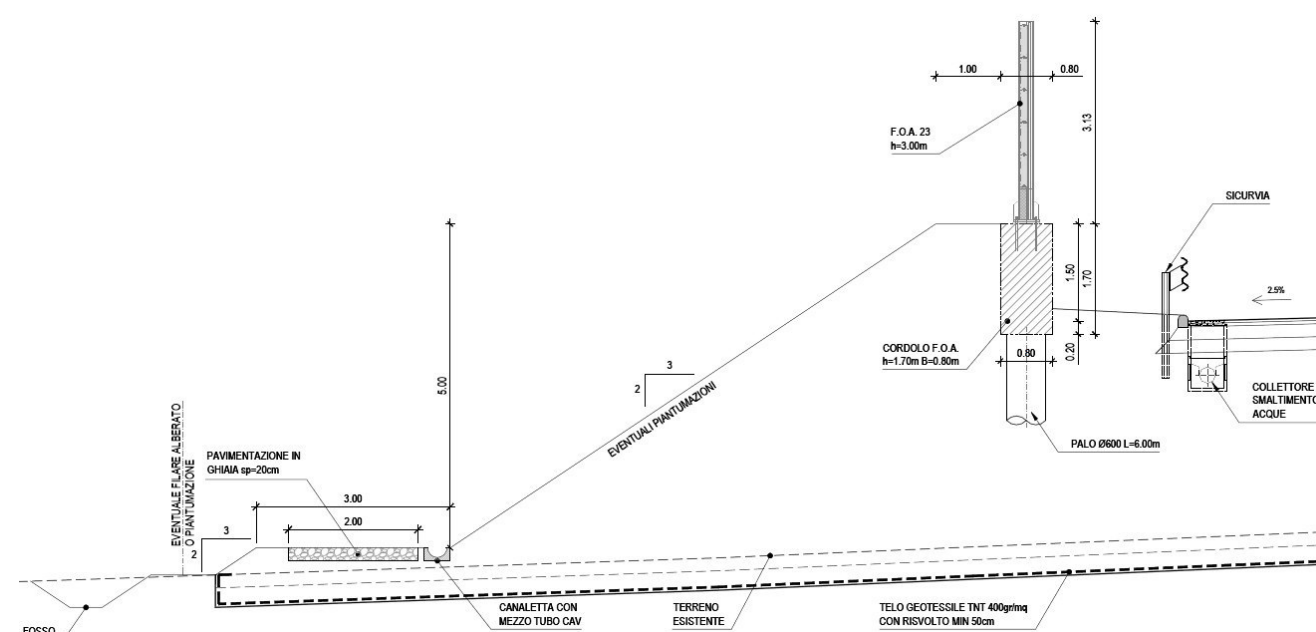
Sezione trasversale tipica del tratto a monte di Villa Luisa
